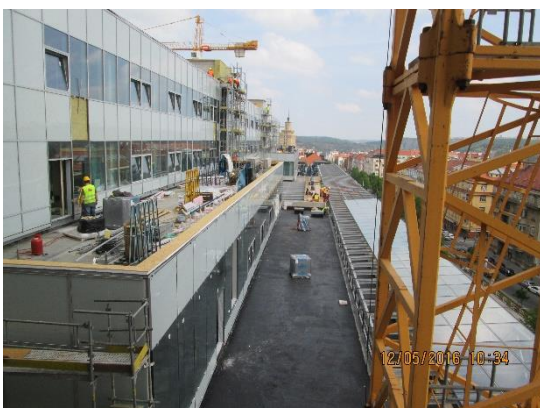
budova B – nepořádek na stavbě, špatné skladování materiálu (Archiv autora)
